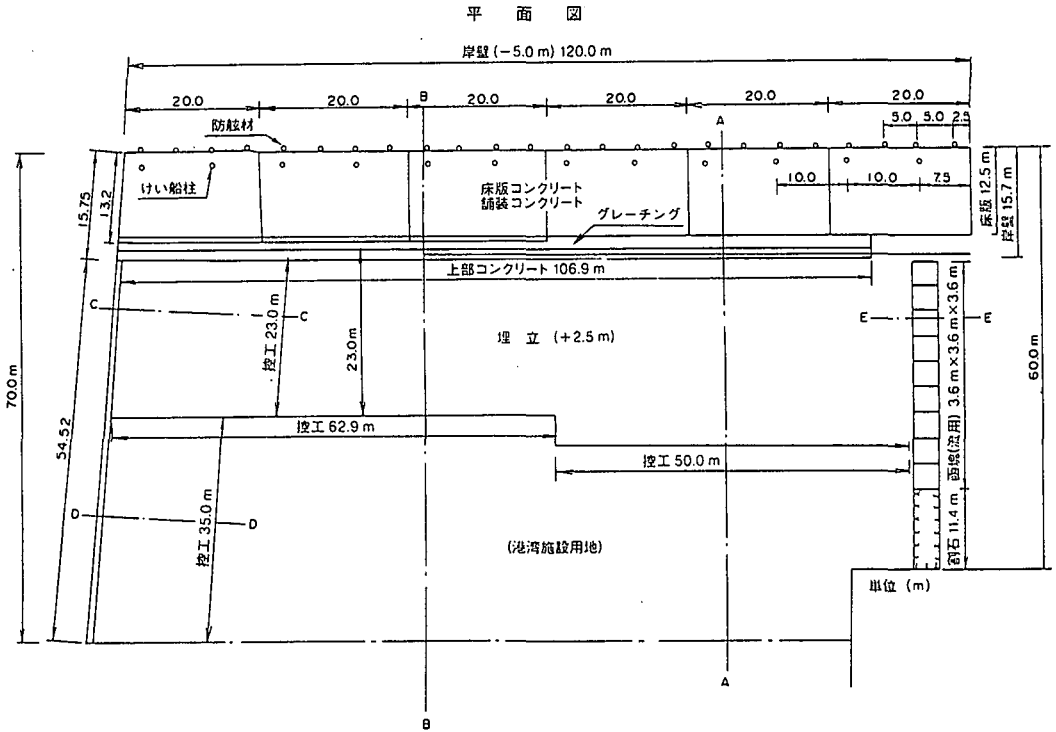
函館港豊川地区豊川埠頭岸壁 (-5.0 m) 平面図
